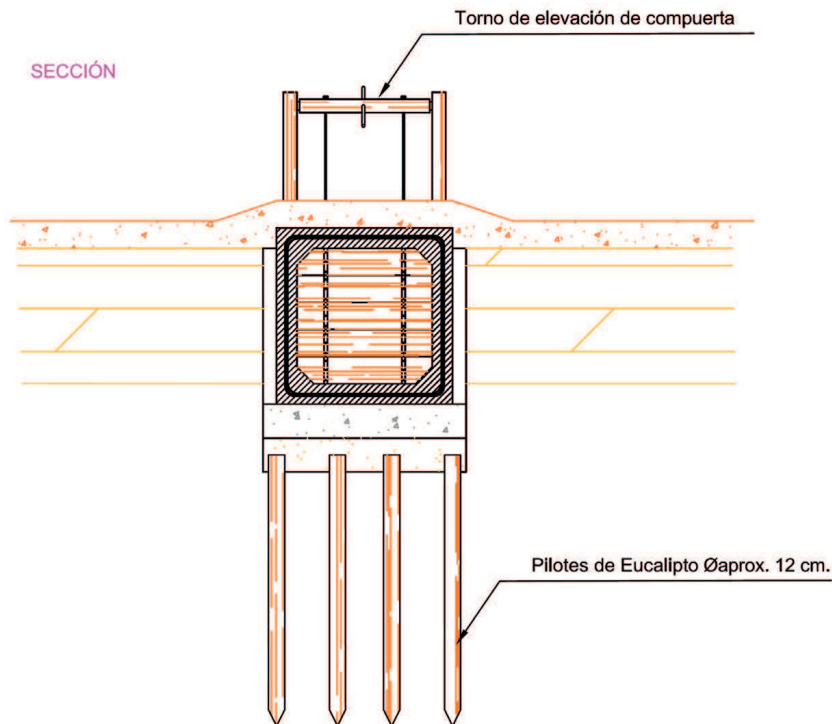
Sección tipo para la colocación de compuerta. Fuente: Demarcación General de Costas.
